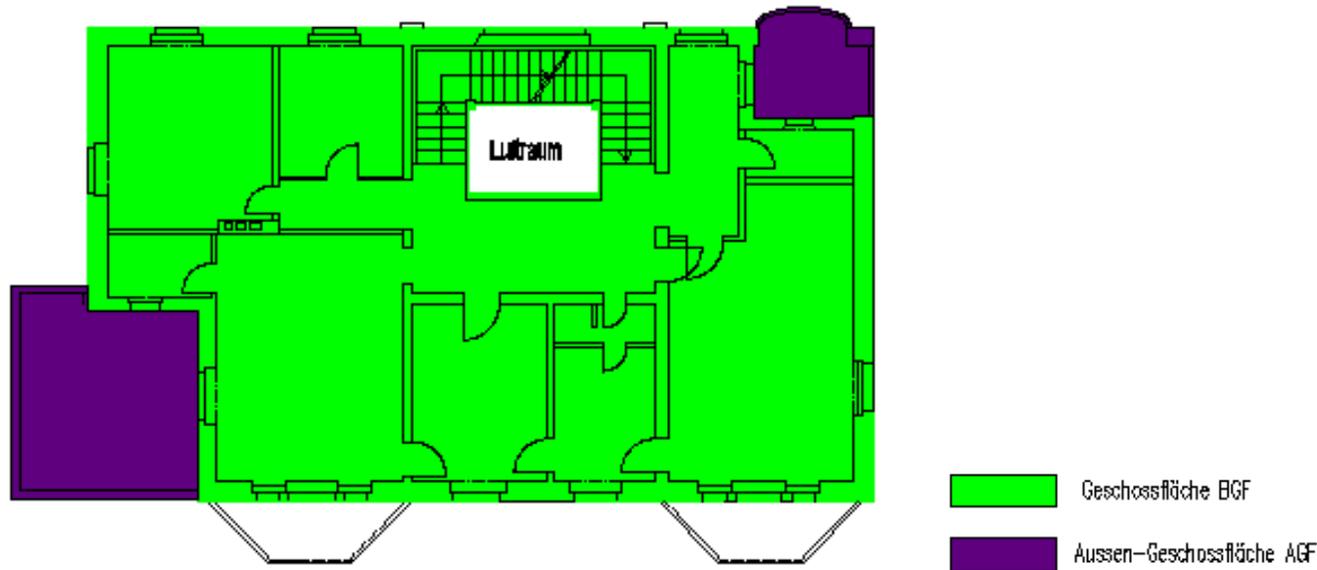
Darstellung Geschossflächen und Aussen-Geschossflächen
